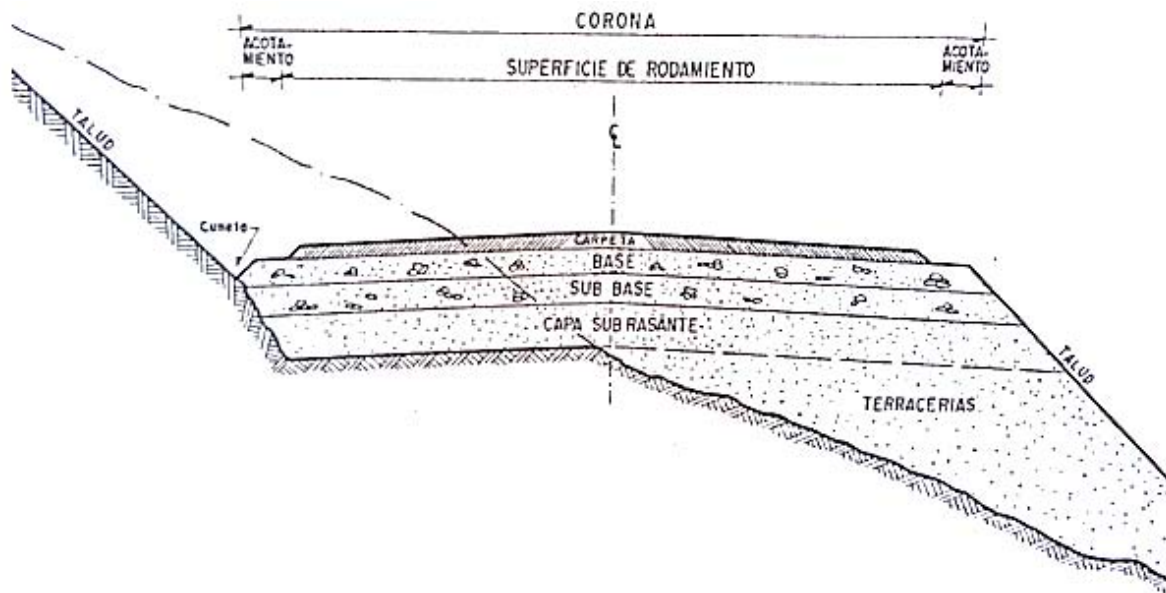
Estructura y sección transversal de un pavimento flexible en balcón.
